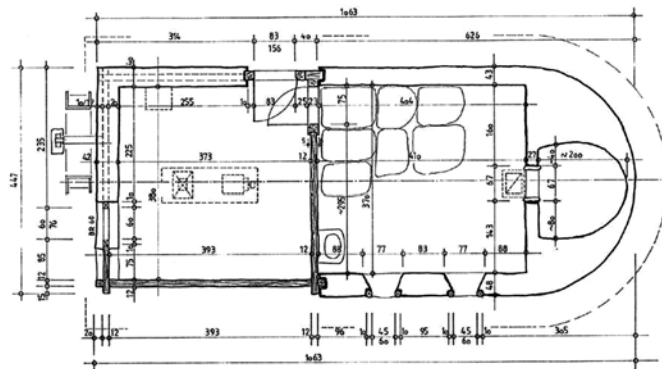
Grundriss der Mühle Blatten, rechts im Bild der Ofen.<sup>5</sup>
